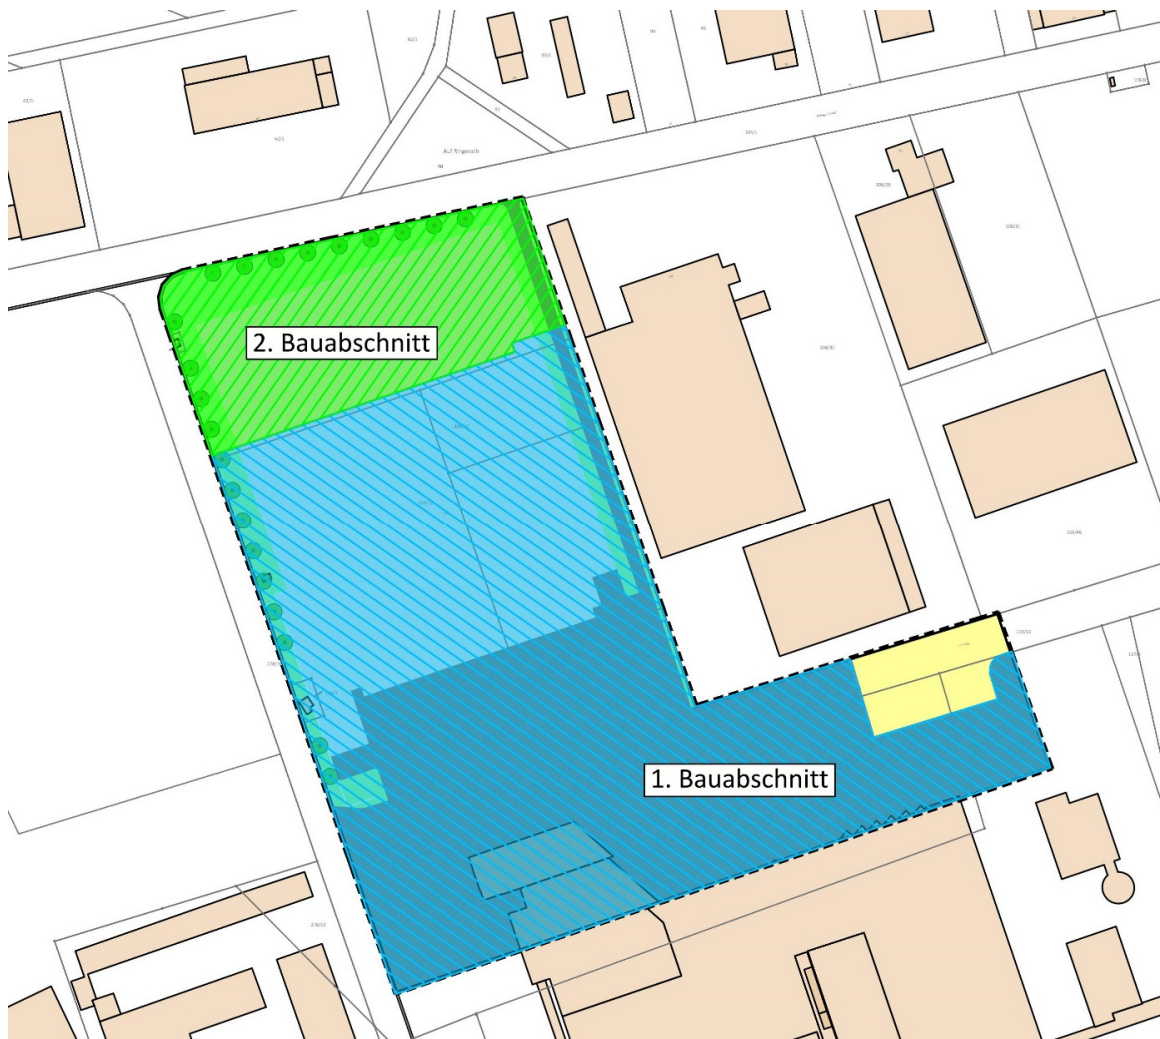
Übersichtskarte geplante Bauabschnitte im Geltungsbereich Bebauungsplan WW-07-02 „Industriegebiet Wengerohr“
